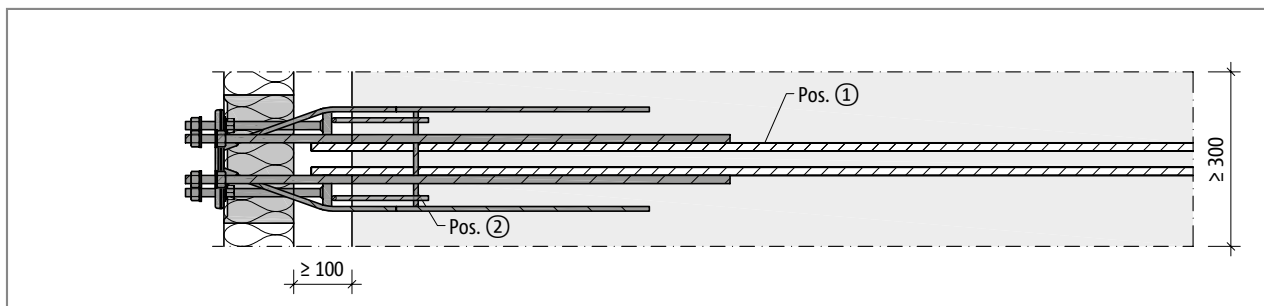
Schöck Isokorb® Typ KSXT14: Bauseitige Bewehrung bei Fertigteilbauweise, Grundriss
